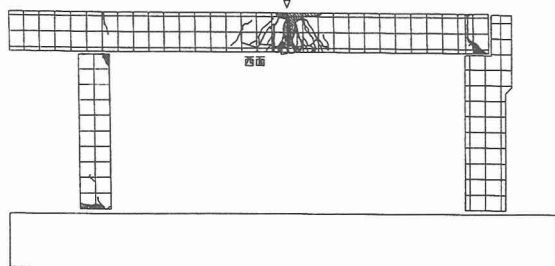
ひび割れ状況(I-2, H=2.0m)
